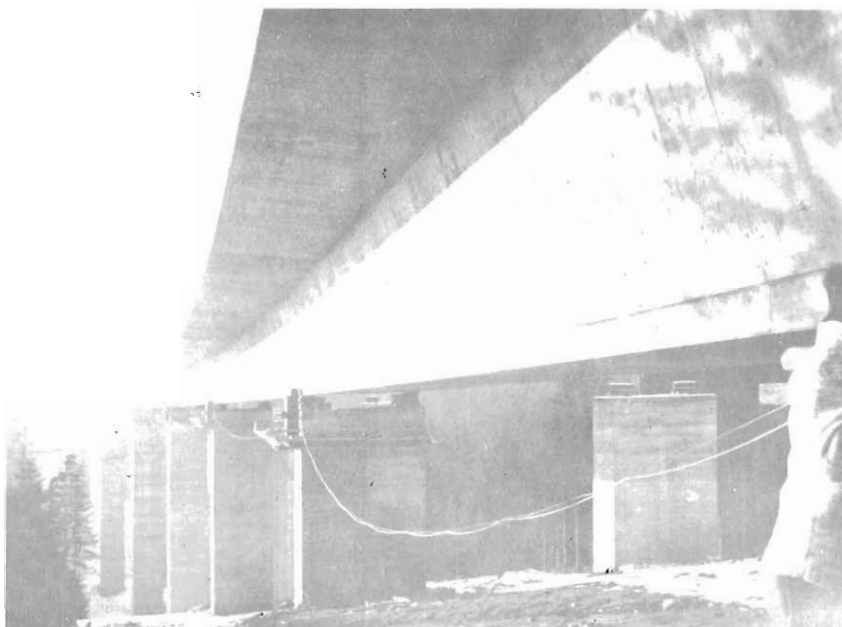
Viaducto de Klagenfurt construido por empujamiento.
